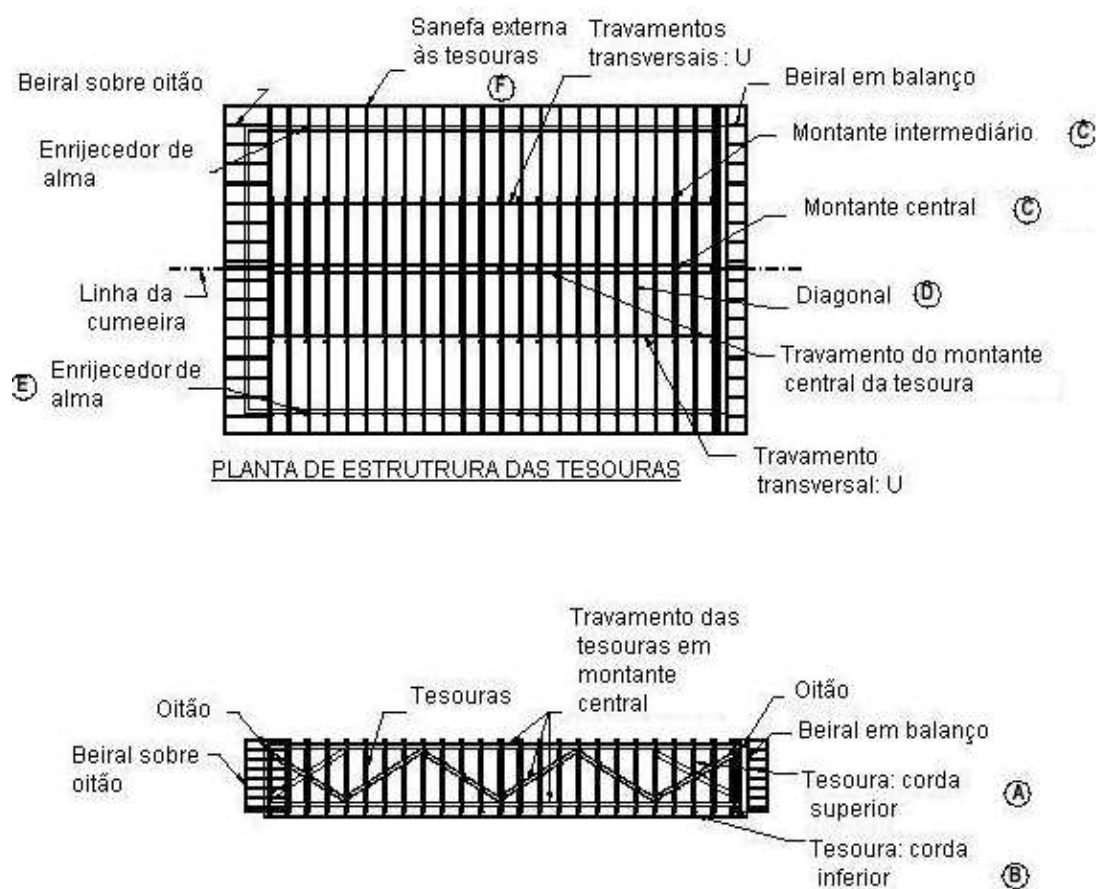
Elementos de uma estrutura de telhado inclinada com travamento longitudinal por contraventamentos com travessas longitudinais (terças) e travamento transversal (Fonte: IAS, 2003)
